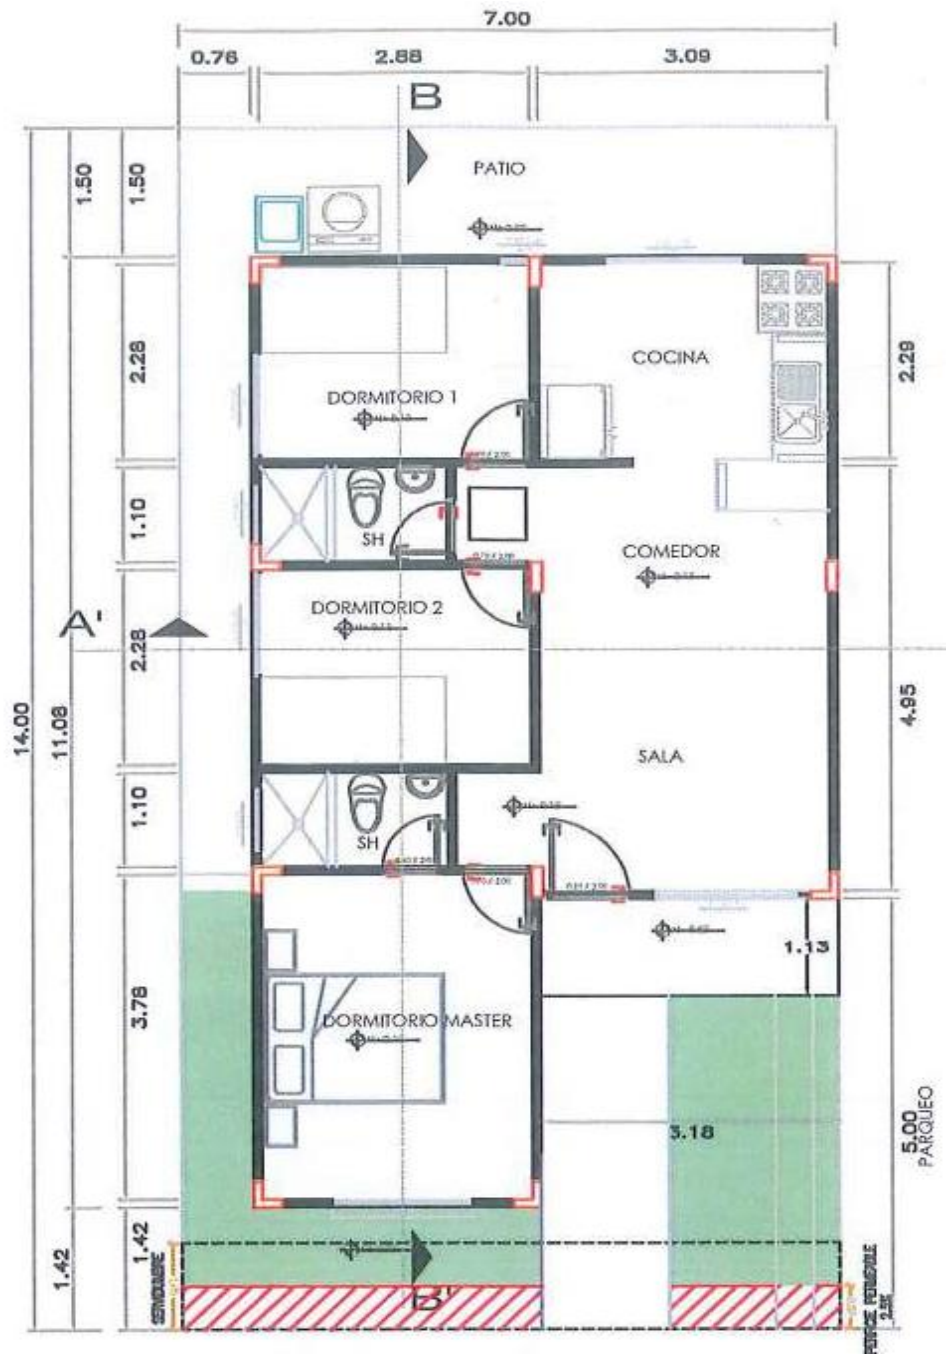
Dimensionamiento planta arquitectónica modelo Arcoíris.
